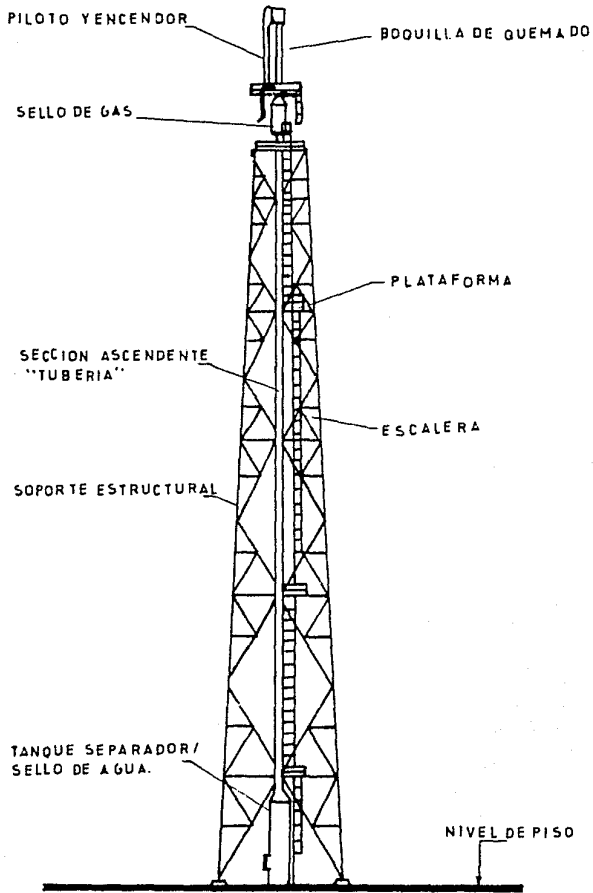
QUEMADOR ELEVADO TIPO TORRE, CON SOPORTE ESTRUCTURAL TRIANGULAR
